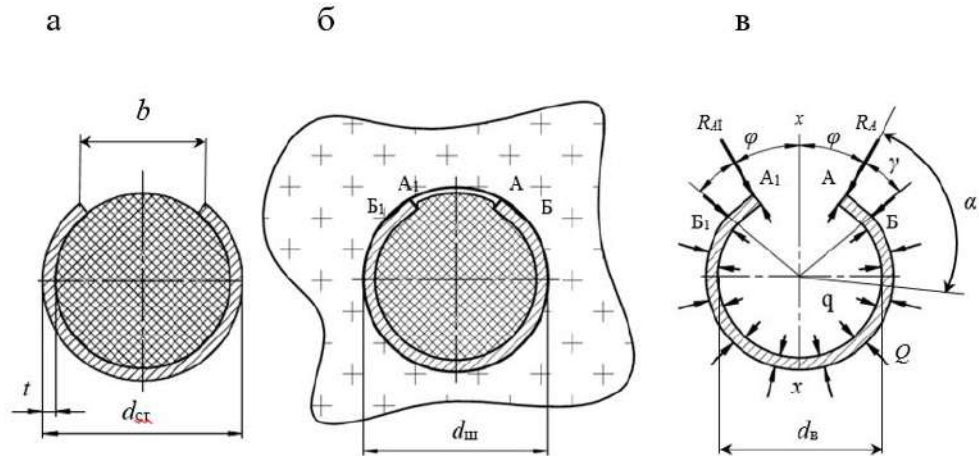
Поперечное сечение, выполненное в передней части стержня: а – сечение стержня анкера до установки в шпур; б – после установки в шпур; в – схема нагружения стержня анкера
